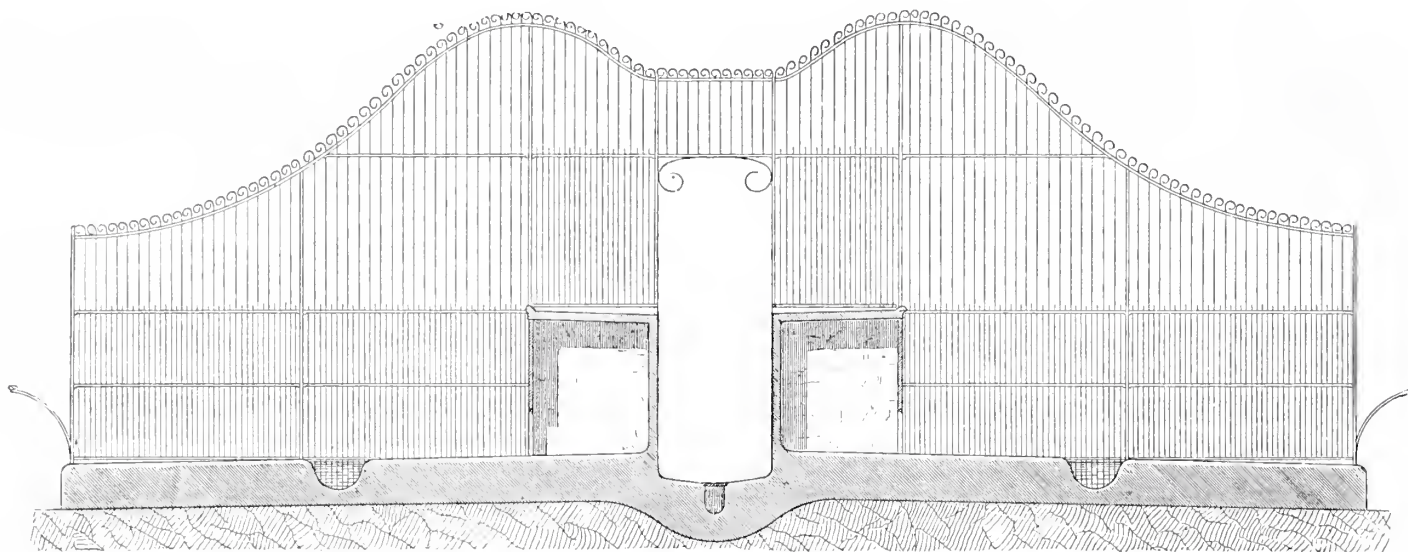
Coupe suivant AB du plan (fig. 1).
